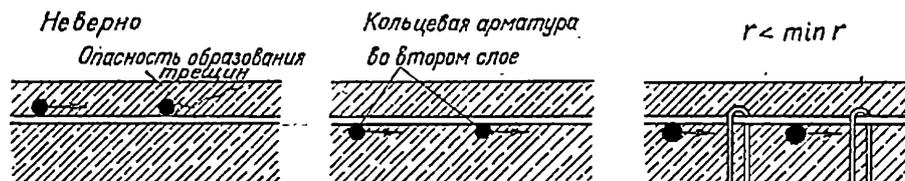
6. Предотвращение откола защитного слоя бетона при кольцевой арматуре
